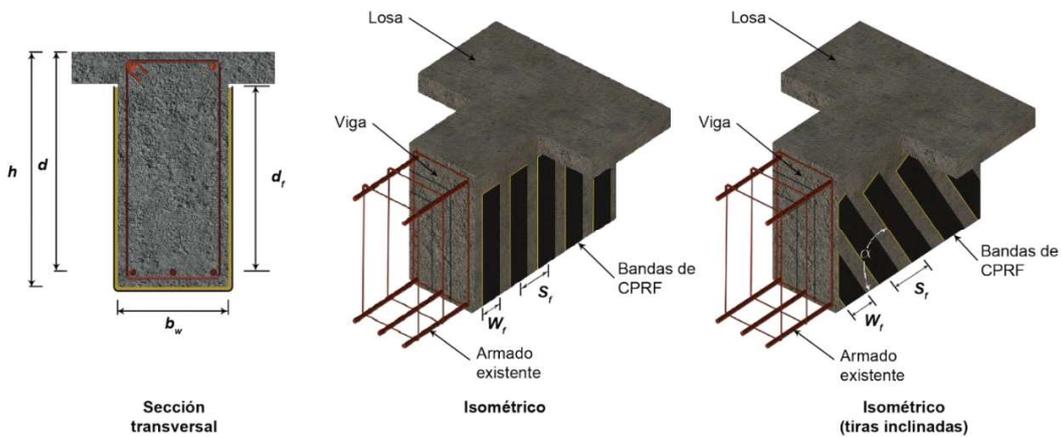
Dimensiones de encamisados (adaptada de ACI 440.2R)
